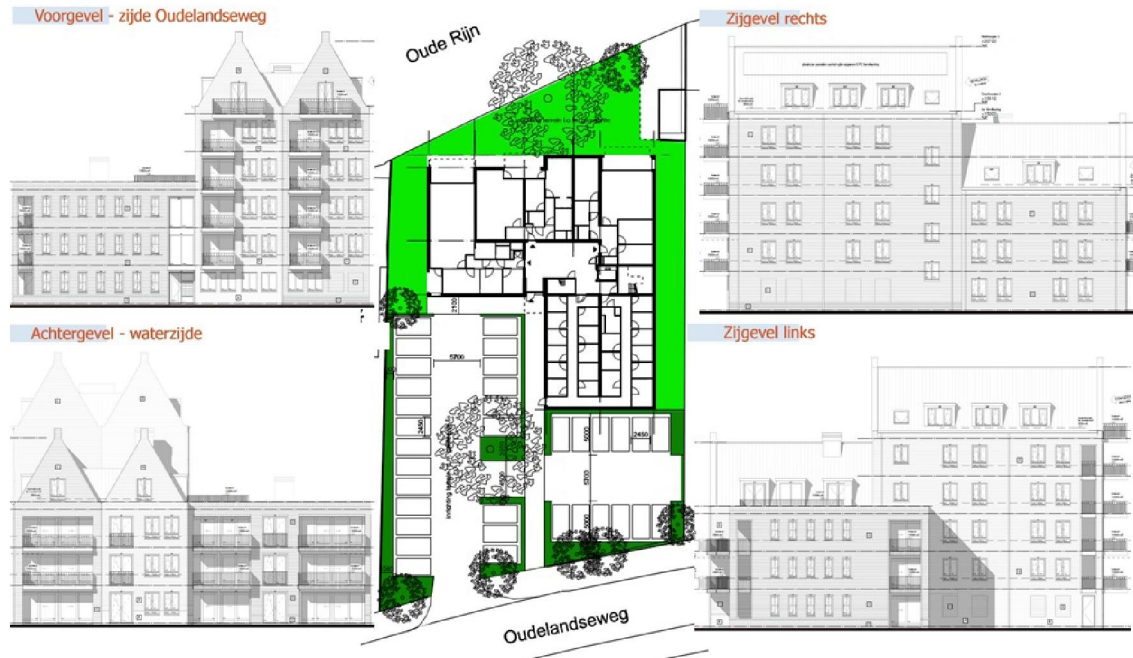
Inpassing van het bouwplan in de omgeving (bron: Venster Architecten)
